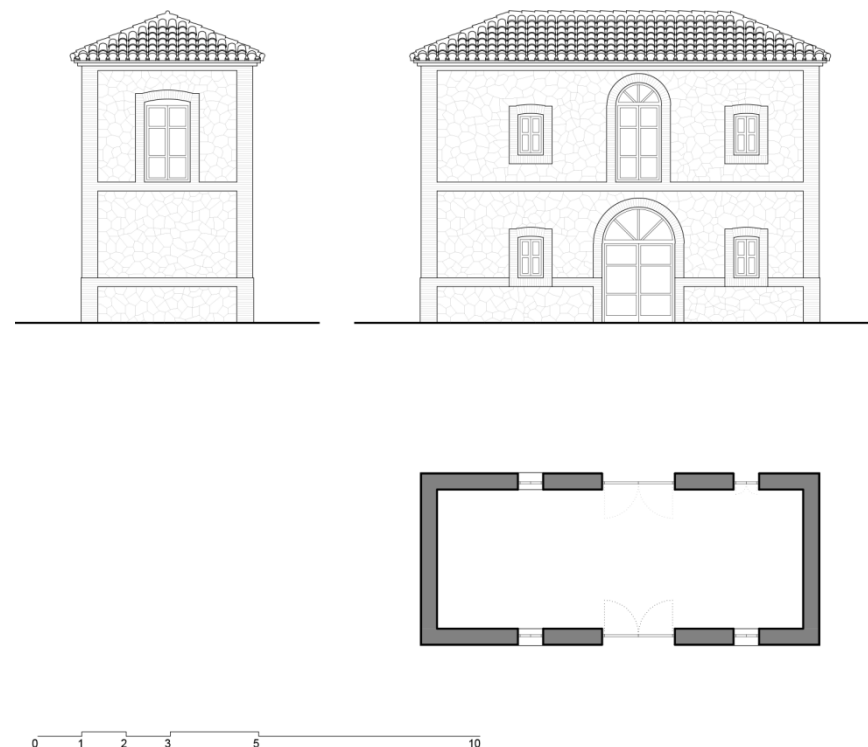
Levantamiento Planimétrico del Pabellón de Costurero-Lavadero.
